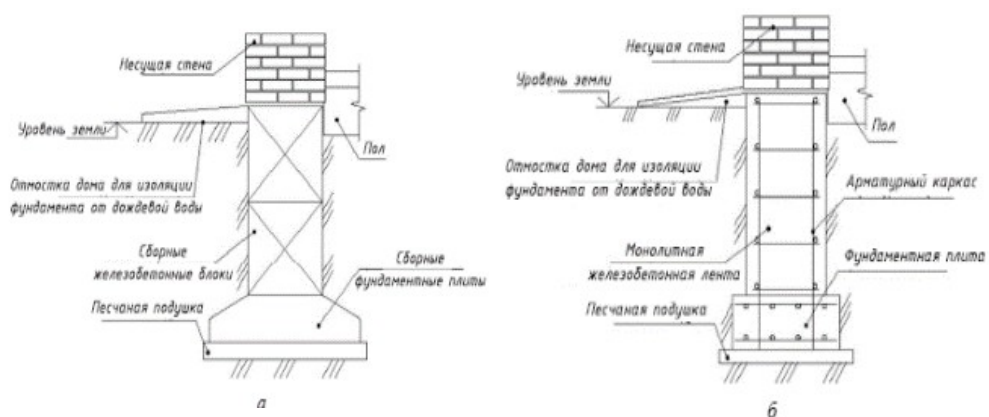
Конструкции ленточных фундаментов: *а* — ленточный сборный фундамент; *б* -ленточный монолитный фундамент
